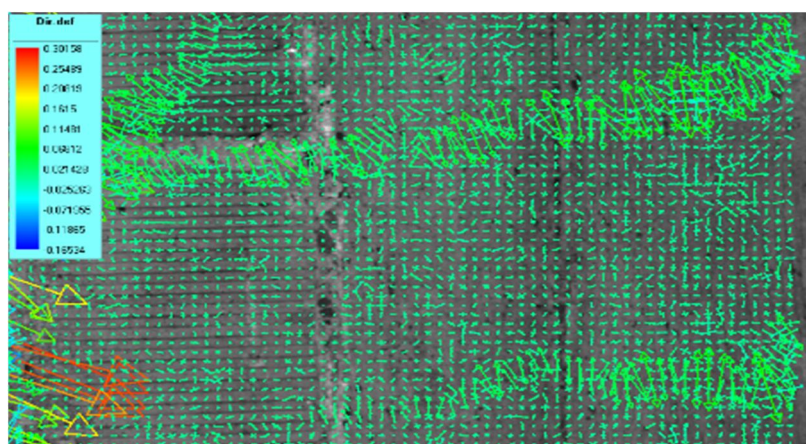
2 : Fissuration du poteau de droite du PC2 d'après l'image (f) de la figure II.4.4.
